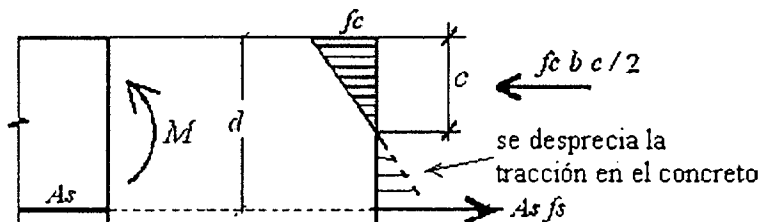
Fuerzas en el concreto y en el acero luego del agrietamiento.
